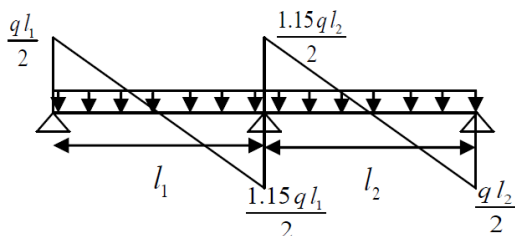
Effort tranchant sur une poutre à 2 travées
